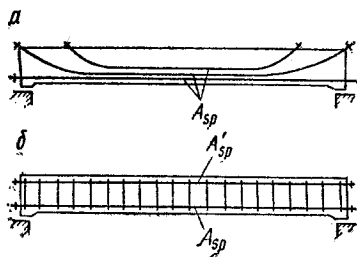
Примеры размещения арматуры в растянутой зоне поперечного сечения предварительно напряженных балок
